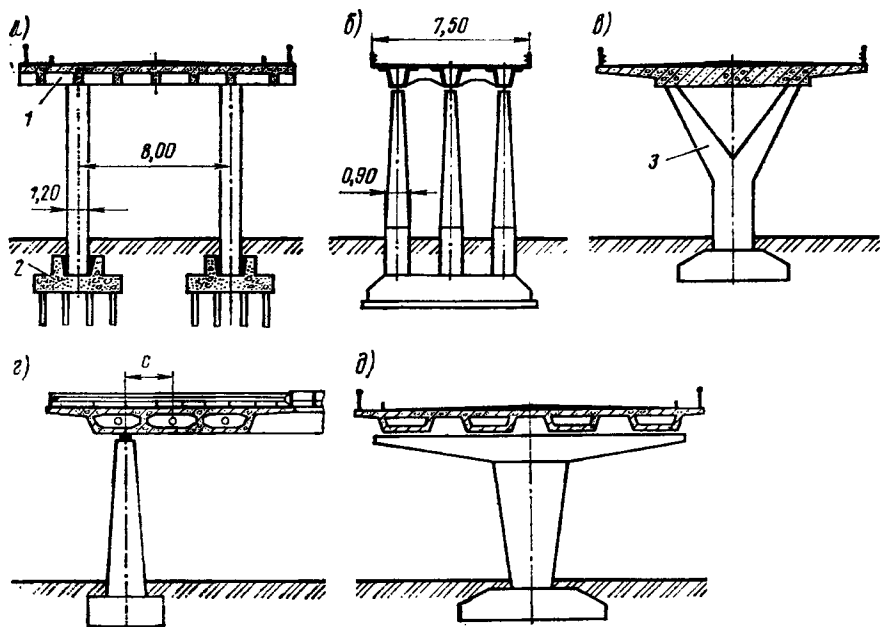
Разновидности стоечных и столбчатых опор железобетонных эстакад: 1 — скрытый ригель; 2 — фундамент стаканного типа; 3 — разветвление столбчатой опоры
